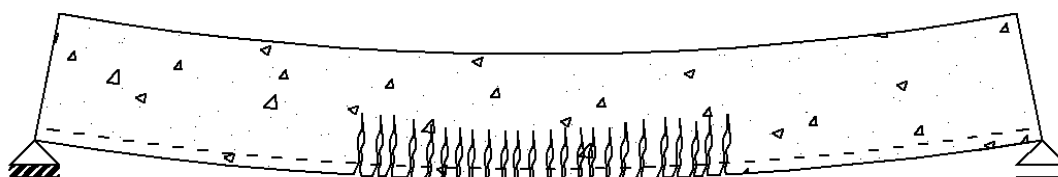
Modelo de viga de betão armado com abertura de fendas devidas à flexão.
